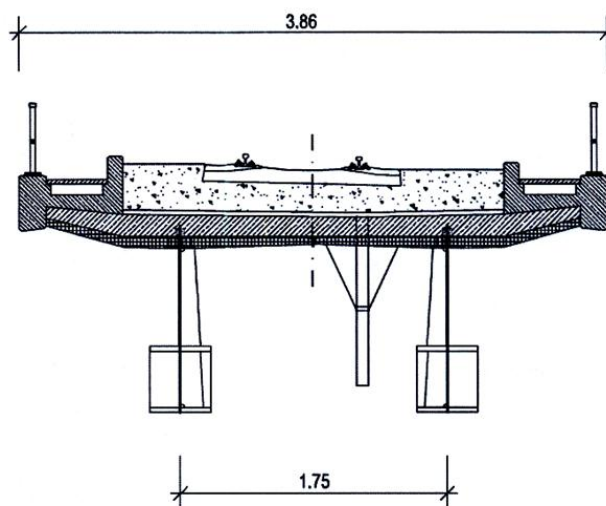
Пролетное сечение двухбалочного железнодорожного моста с монолитной железобетонной плитой на металлических балках с развитым нижним поясом [13]
